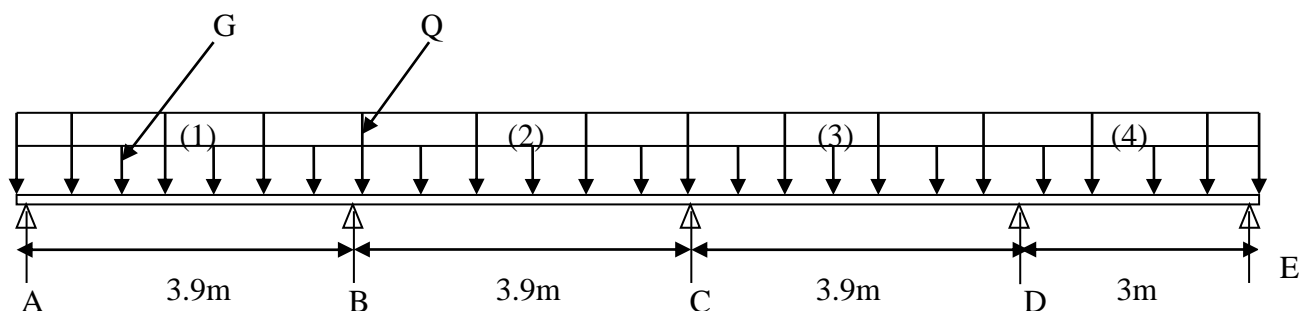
Schéma statique de la poutrelle la plus défavorable.
